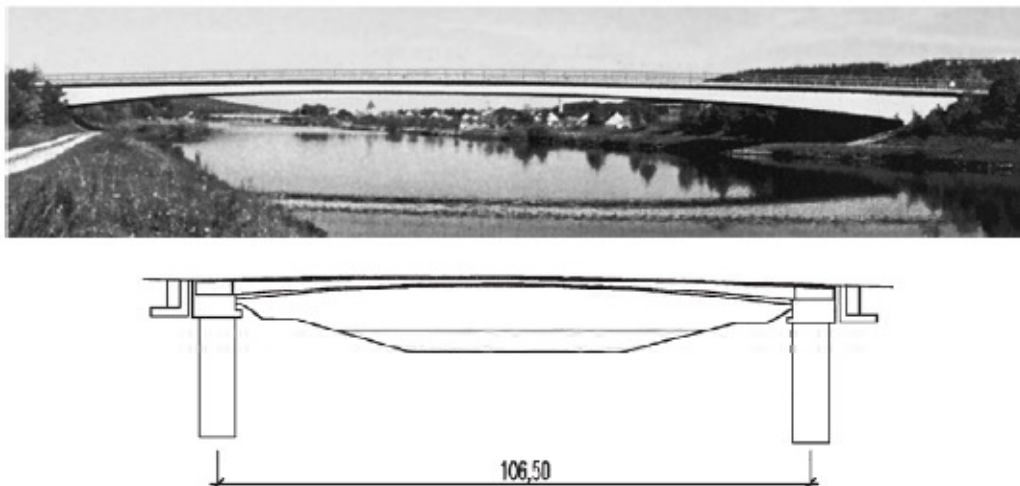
Southern Viaduct Berching, foto e sezione longitudinale (Braun, 2006)
